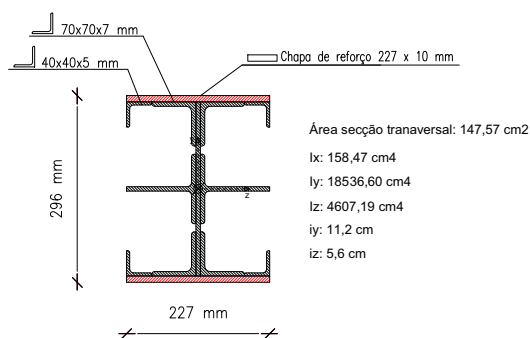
Reforço do elemento MT2 da viga principal.
